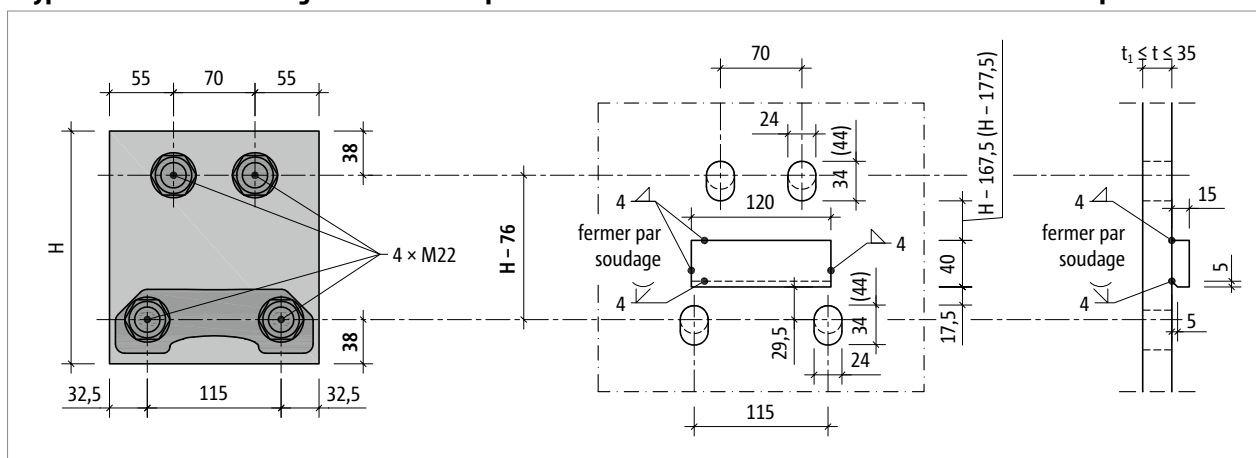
Schöck Isokorb® T type SK-MM2-...-CV28 : structure du raccordement de la plaque frontale avec enrobage de béton CV28
